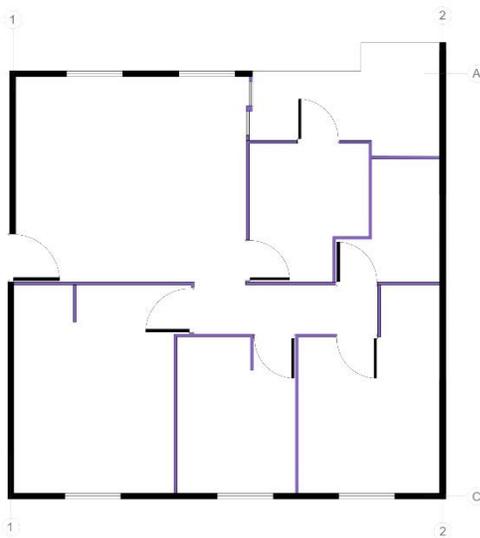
Ejes estructurales. Fuente: Elaboración propia.
